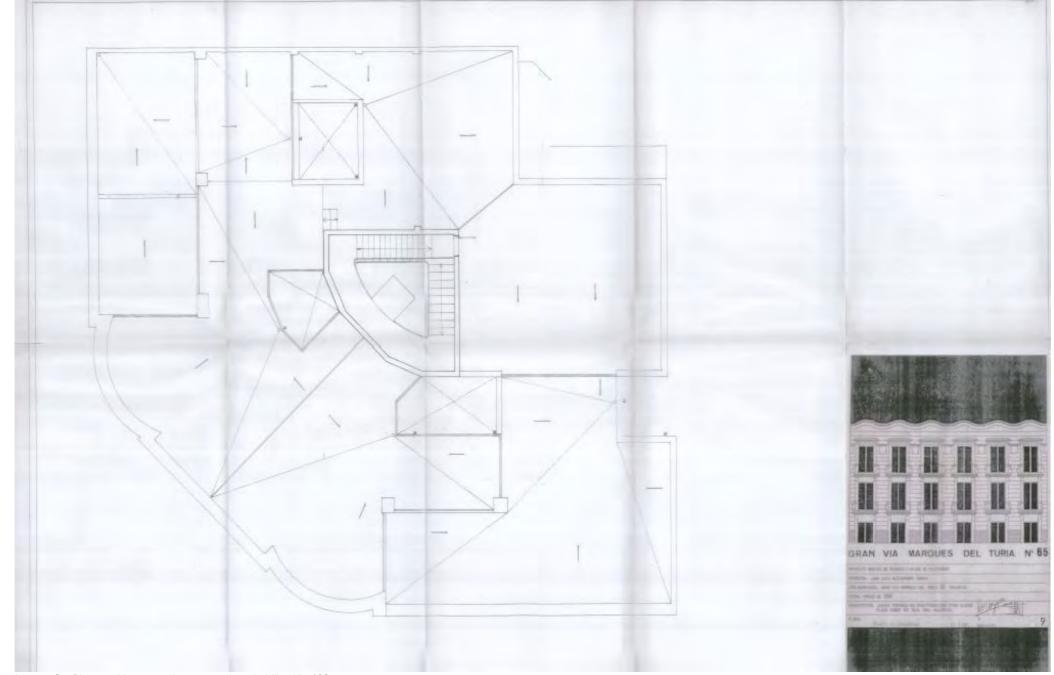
Planta cubierta estado proyectado, rehabilitación 1985
